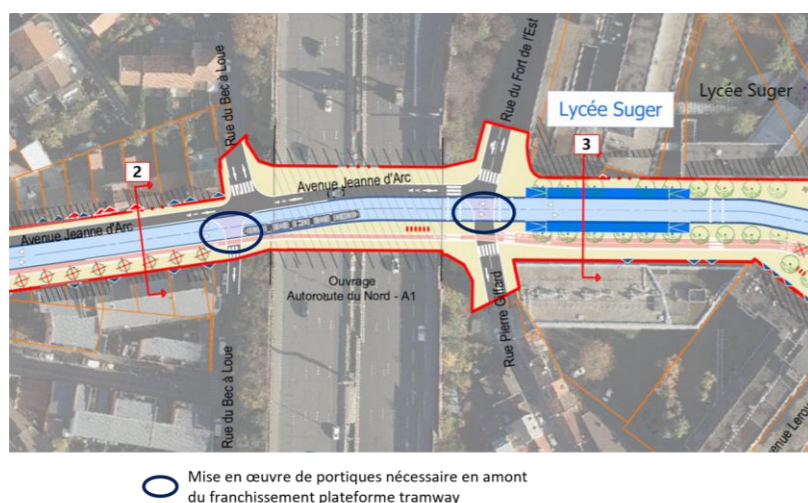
Localisation de portiques en amont du franchissement de la plateforme tramway pour les deux carrefours encadrant l'ouvrage pont-route A1 avenue Jeanne d'Arc
